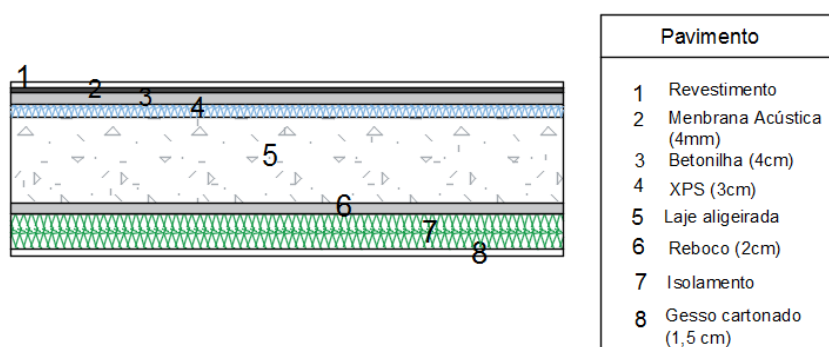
Pormenor e constituintes do pavimento da solução de reabilitação 2
